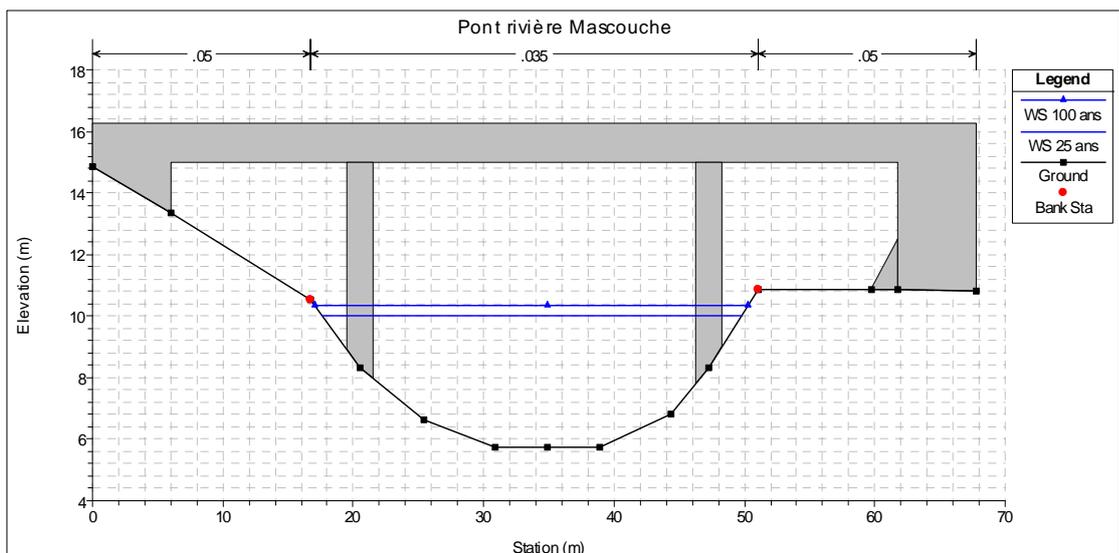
Section travers pont : niveaux 1:25 (10,0 m) et 1:100 ans(10,3 m)
